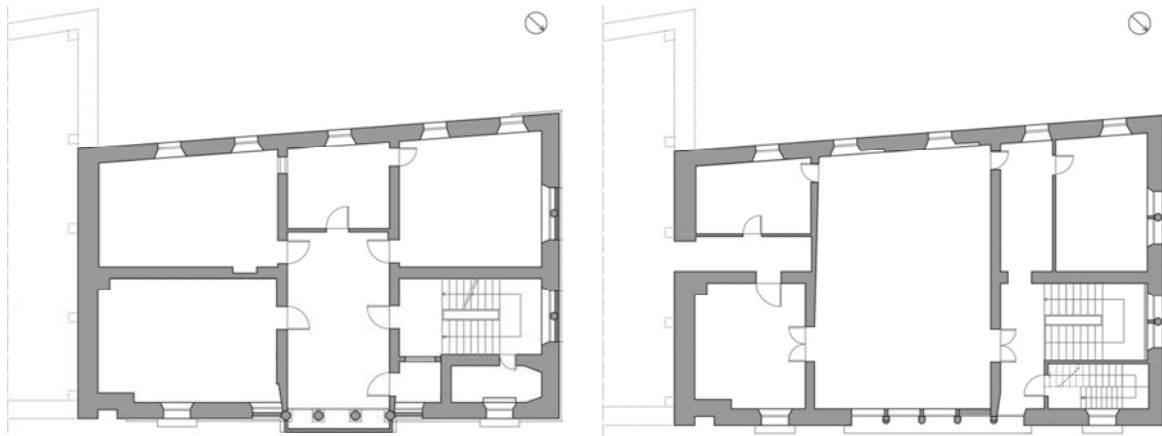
Pianta piano primo e pianta piano secondo.
